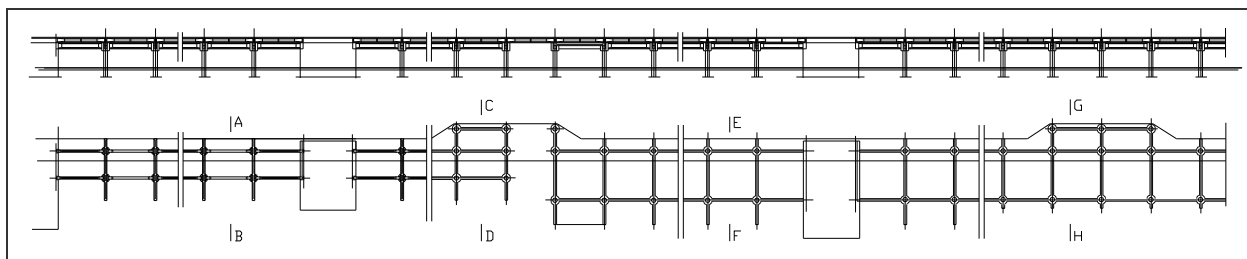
Alçado e planta da estrutura inferior do viaduto do Terminal de Petroleiros. Desenhado a partir de (ENARCO, 1966).
